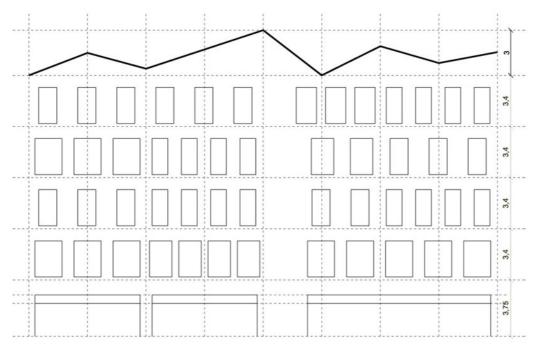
Ejemplo de hastiales paralelos a fachada según la regla 5.
